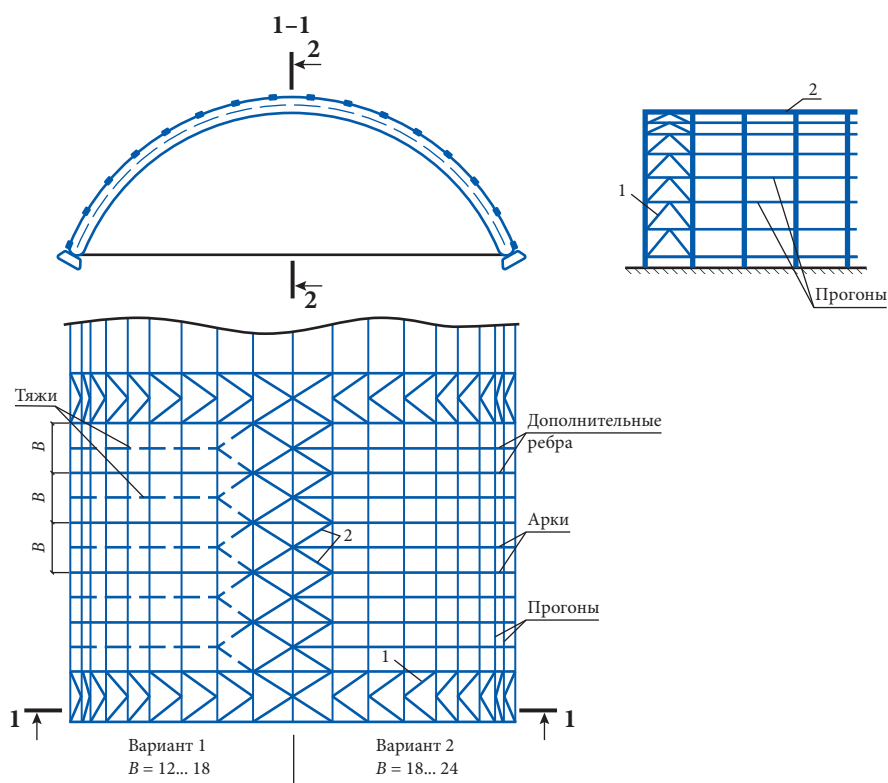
Компоновка арочного покрытия при рядовом расположении арок: 1 — поперечные связи по верхним поясам арки; 2 — продольные связи по верхним поясам арки
